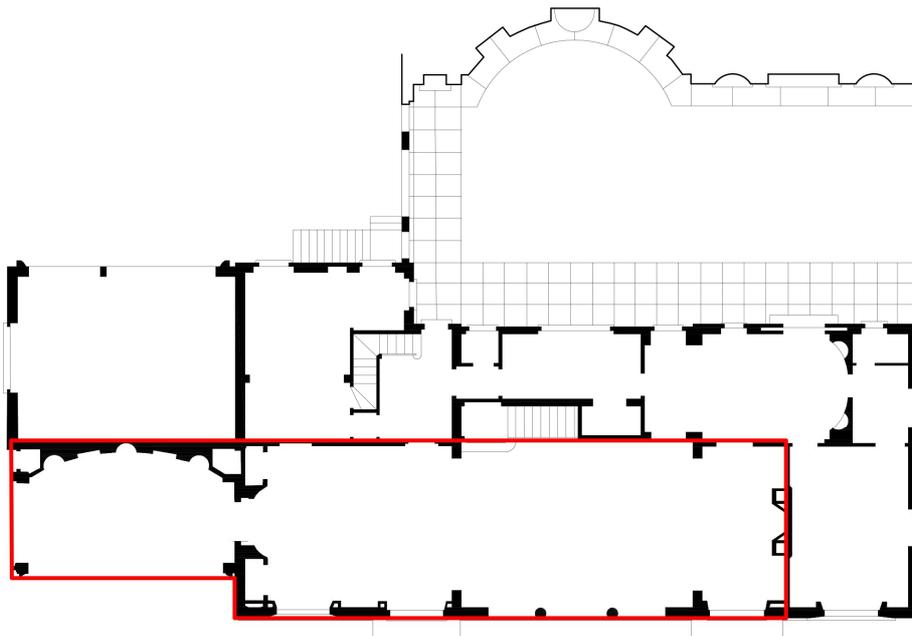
G. Ponti, casa Bouilhet, Garches, 1926, pianta piano terreno, schema: il grande spazio per vivere. La hall e la *salle à manger* sono separabili con una tenda.
